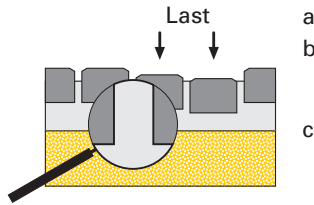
Aufbau Pflasterdecke nach RStO
